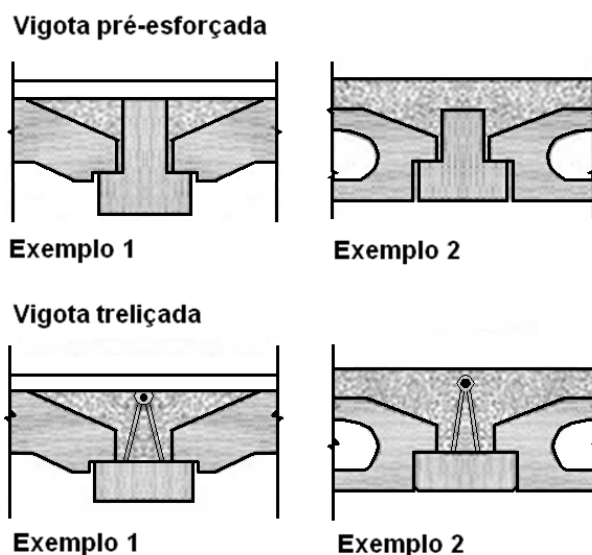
Exemplos de ligação laje-laje com vigotas (Stupré, 1981)
